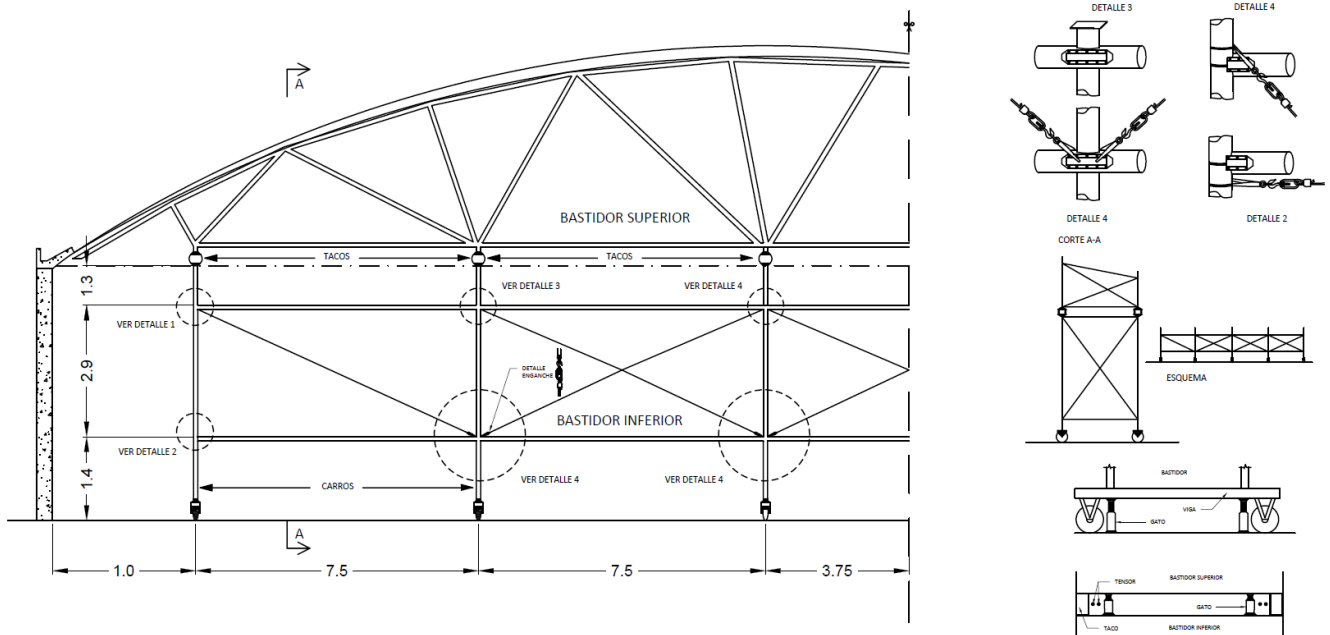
Detalles constructivos de Cimbra móvil Fuente: Elaboración propia
